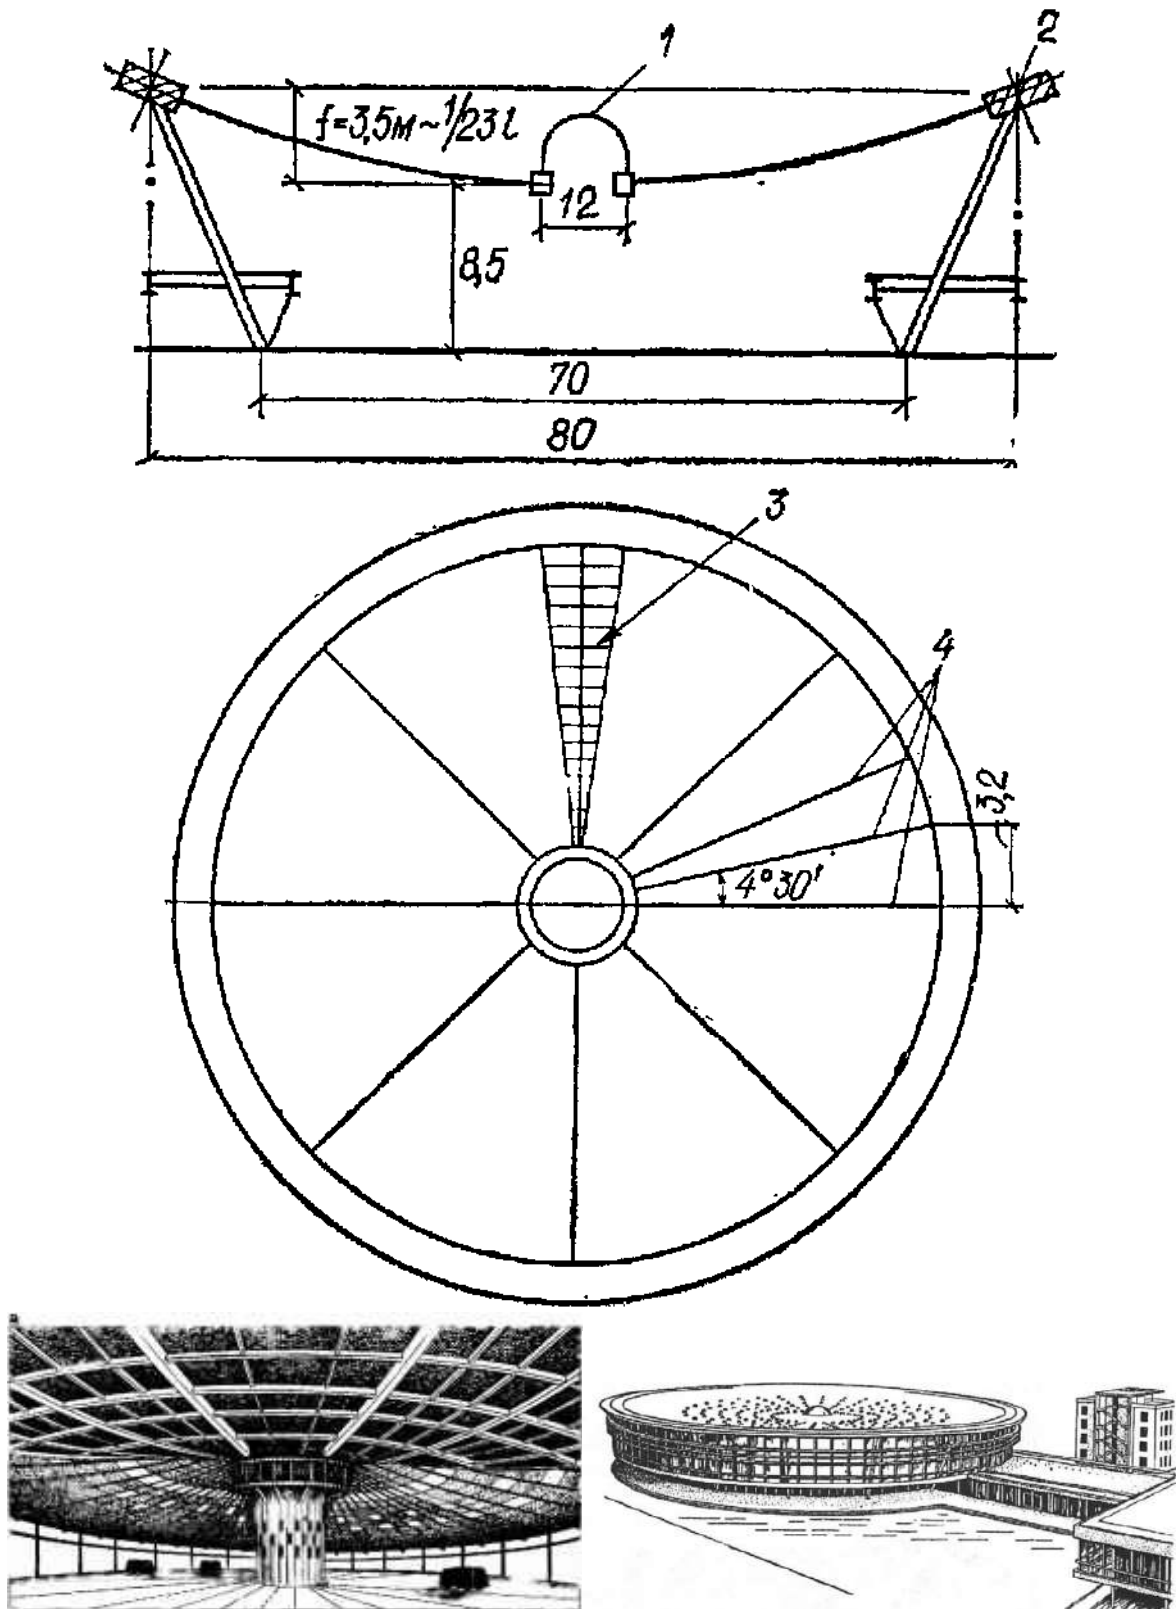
Покрытие рынка в Бауманском районе Москвы: 1 – свето-аэрационный фонарь; 2 – железобетонное кольцо 1x1,5 м; 3 – керамзитобетонные плиты; 4 – тросы 80 шт. > 52,5 мм
